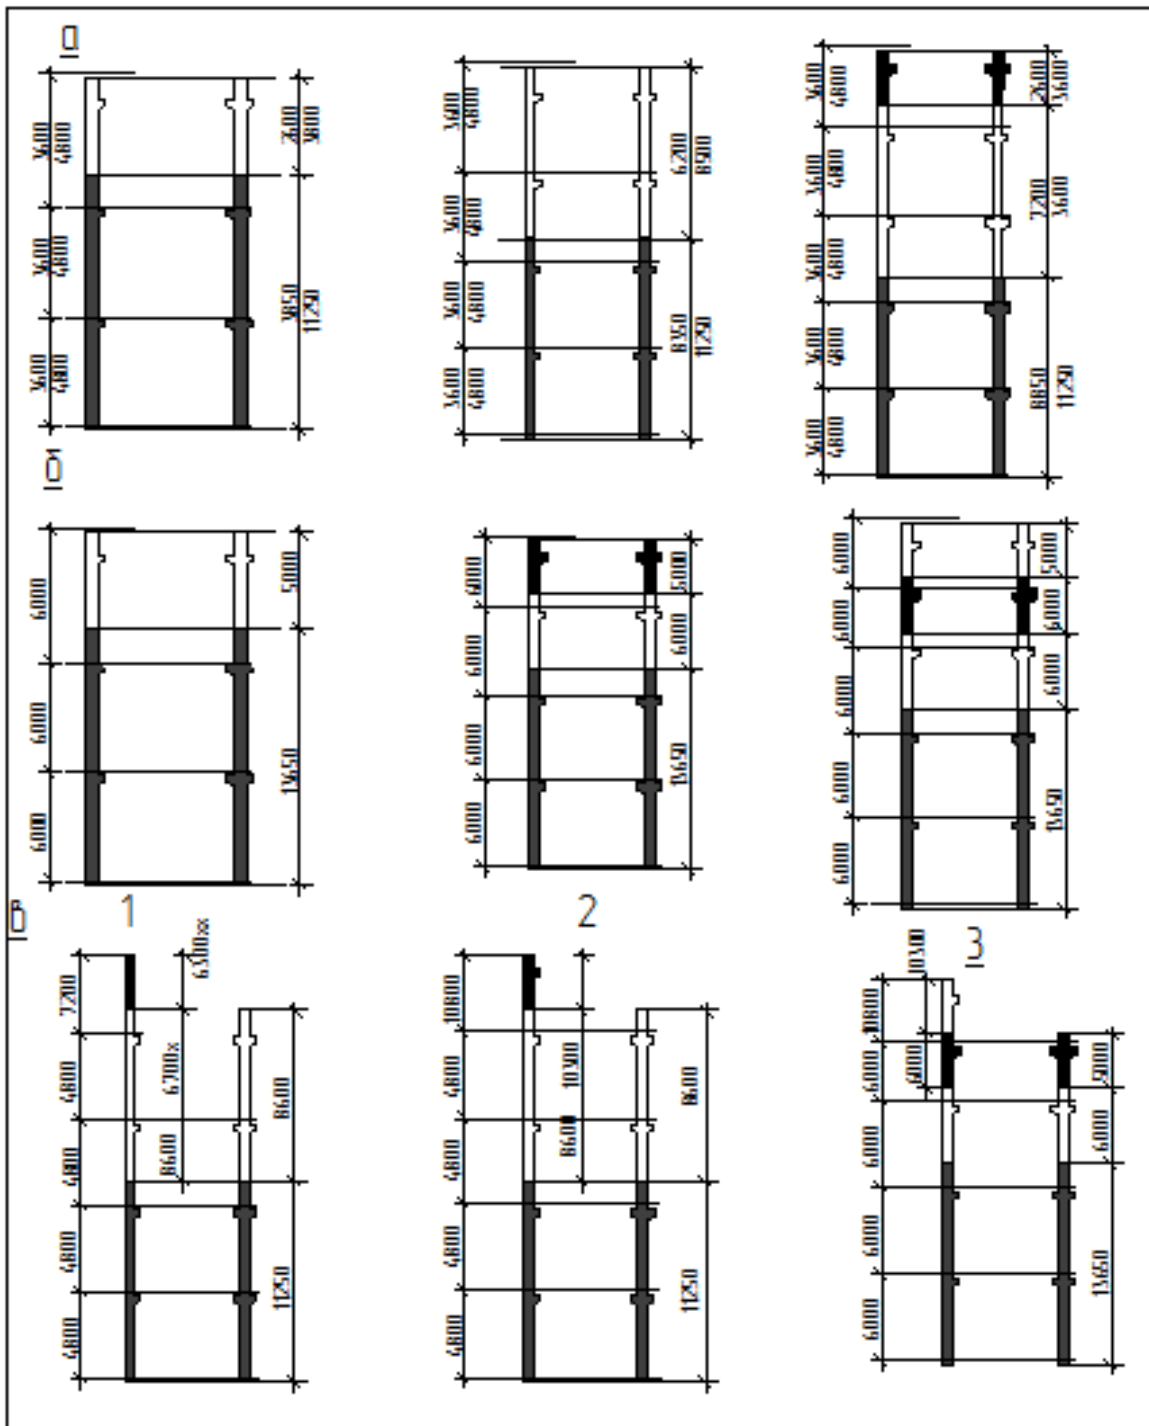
Схеми розрізання колон уніфікованих промислових будівель; а; б – будівлі з сіткою колон 6×6 і 9×6 м; в – будівлі з укрупненою сіткою верхнього поверху; 1 – будівлі з підвісним транспортом; 2, 3 – будівлі з мостовими кранами. Висоти колон 6300 приймаються при опиранні плит покриття на полиці ригелів. Висоти 6700 при опиранні зверху ригелів
